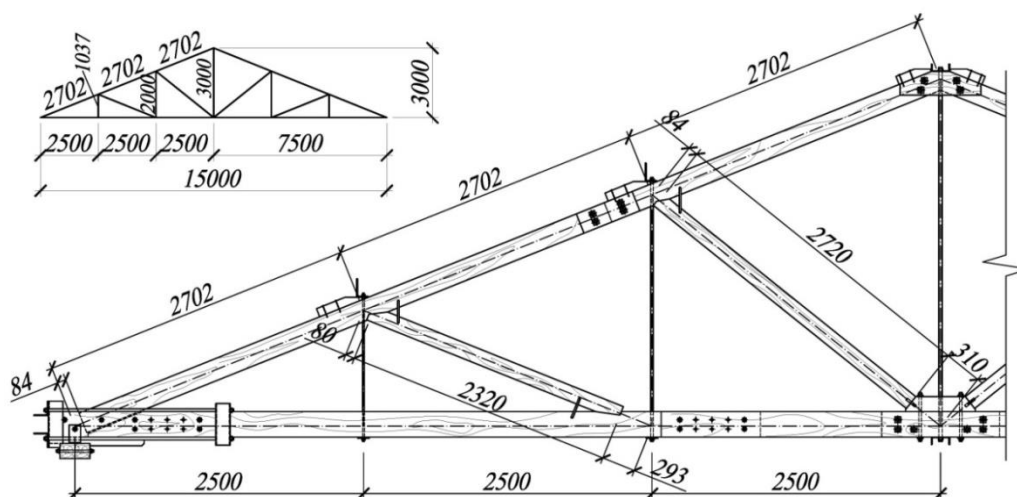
Ферма 1-го варианта с узловыми соединениями на врубках
